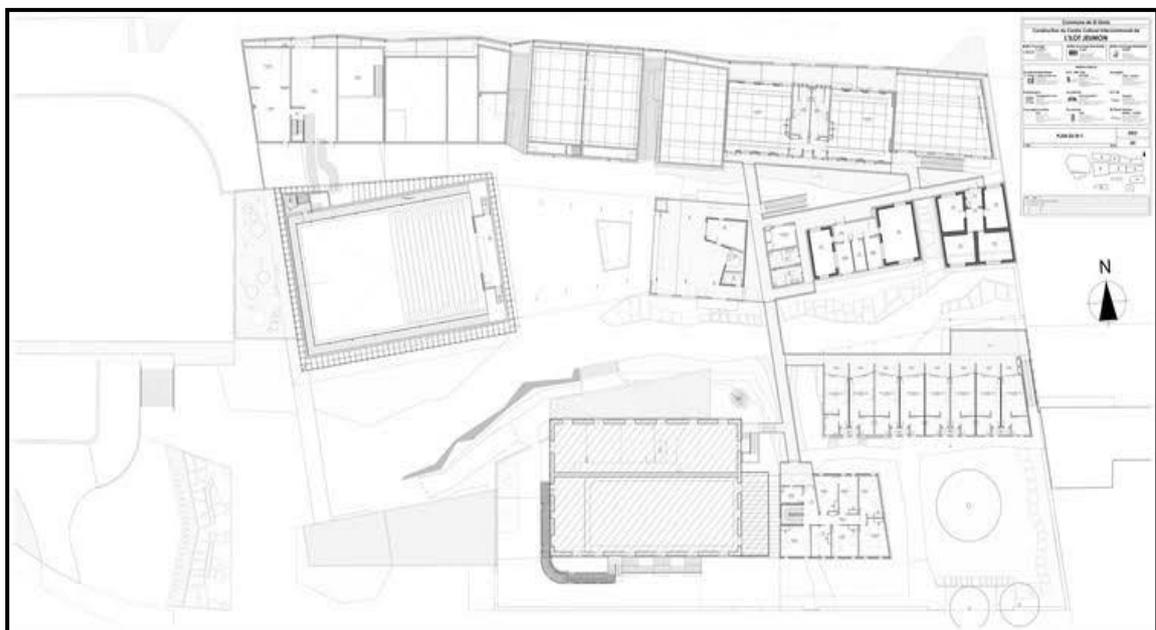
plan de masse de la cité / Source: [www.archdaily.com/795414/la-cite-des-arts-latelier](http://www.archdaily.com/795414/la-cite-des-arts-latelier)
